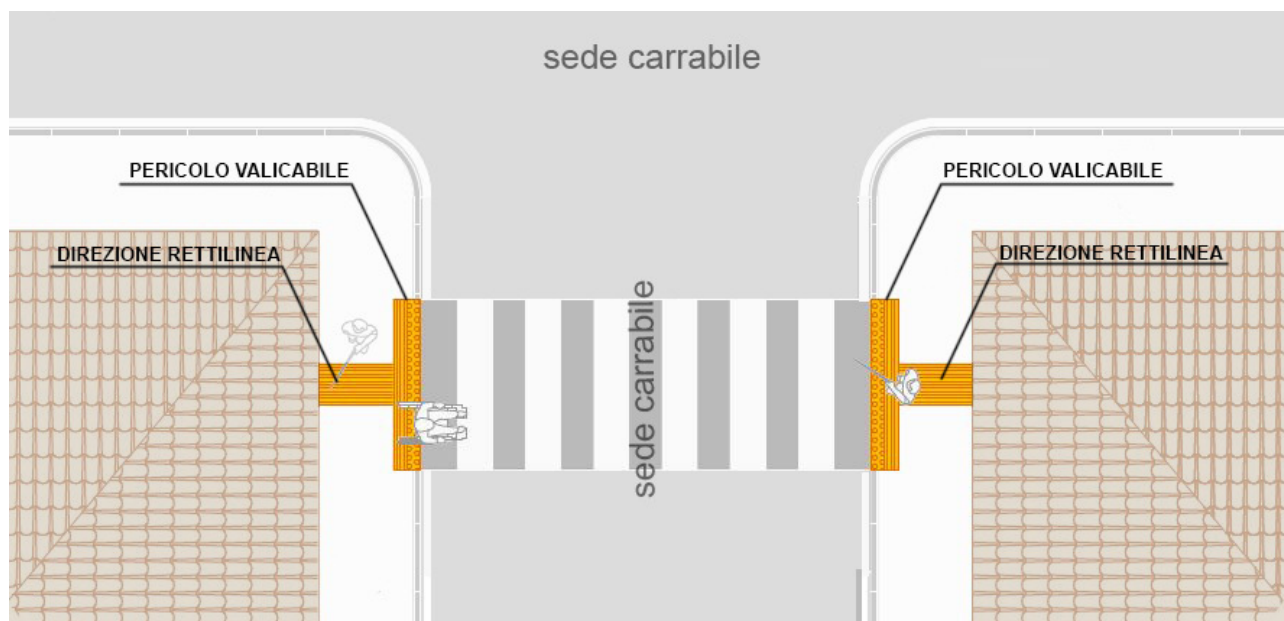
Schema planimetrico tipo: attraversamento pedonale segnato con piastrelle LOGES
